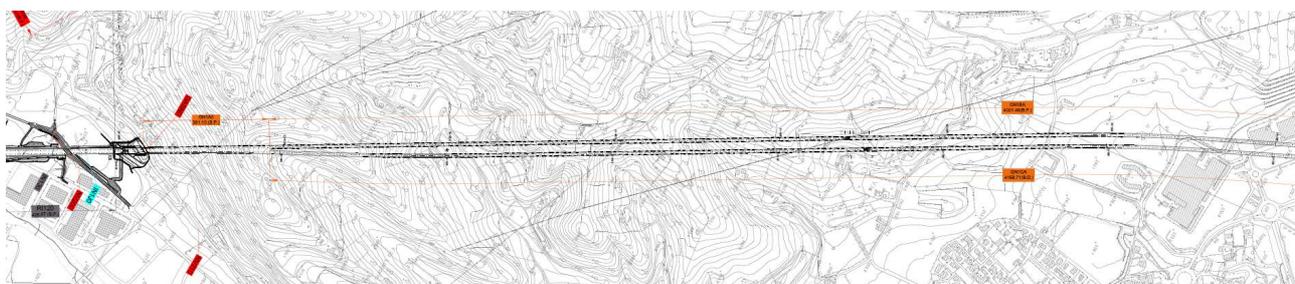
Planimetria generale della Galleria Serravalle – tratta imbocco sud – settore collinare (pk 29+968.70 - 32+300)
